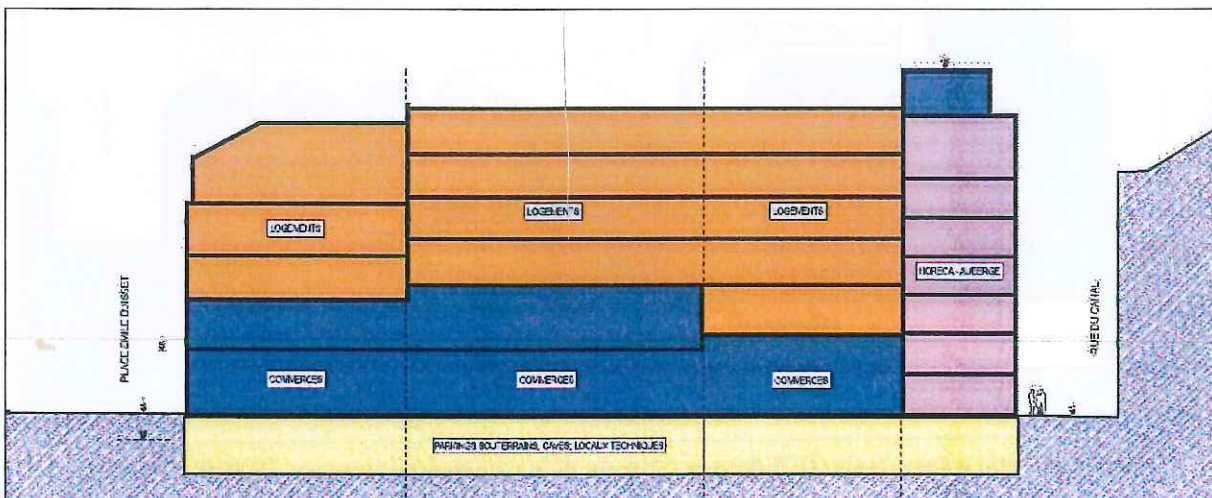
Coupe longitudinale (AA) dans le front bâti sud de l'îlot Buisset (source : DDS & Partners)
